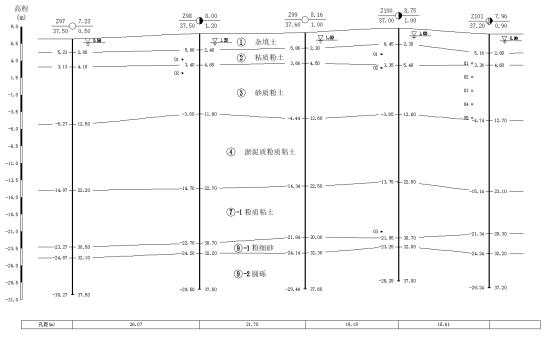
12-12'工程地质剖面图 (项目位置南侧)
